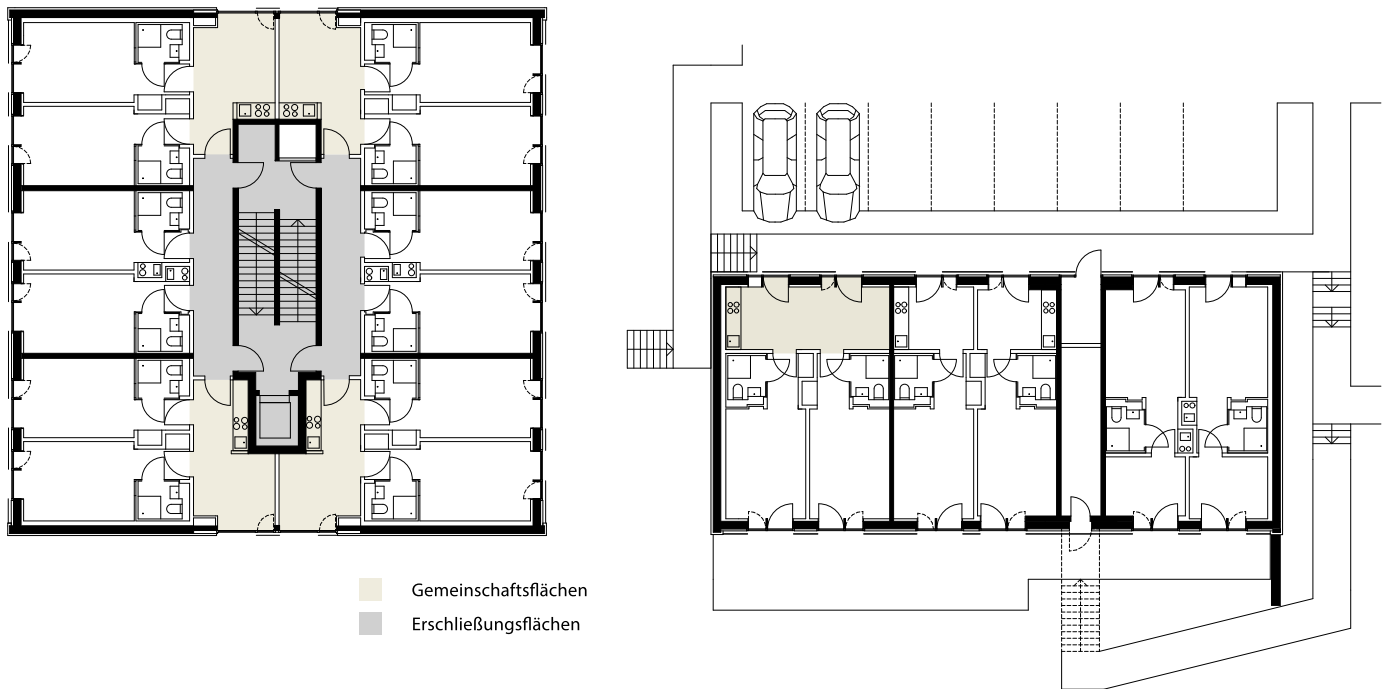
Erschließung und Raumanordnung in den Grundrissen des Solitärs (links) und der Hanghäuser (rechts) unterscheiden sich deutlich, M. 1:300. [© BF Vario]
